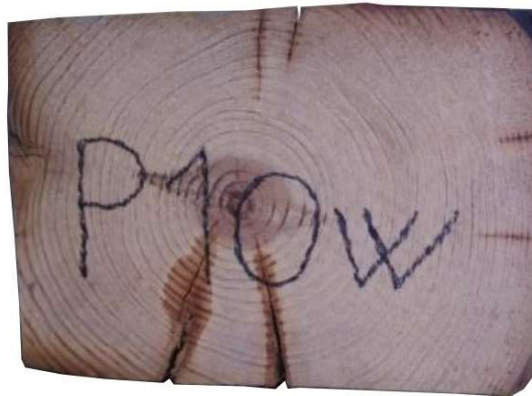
Marcado de las vigas extraídas de la cubierta de la Facultad de Derecho.
